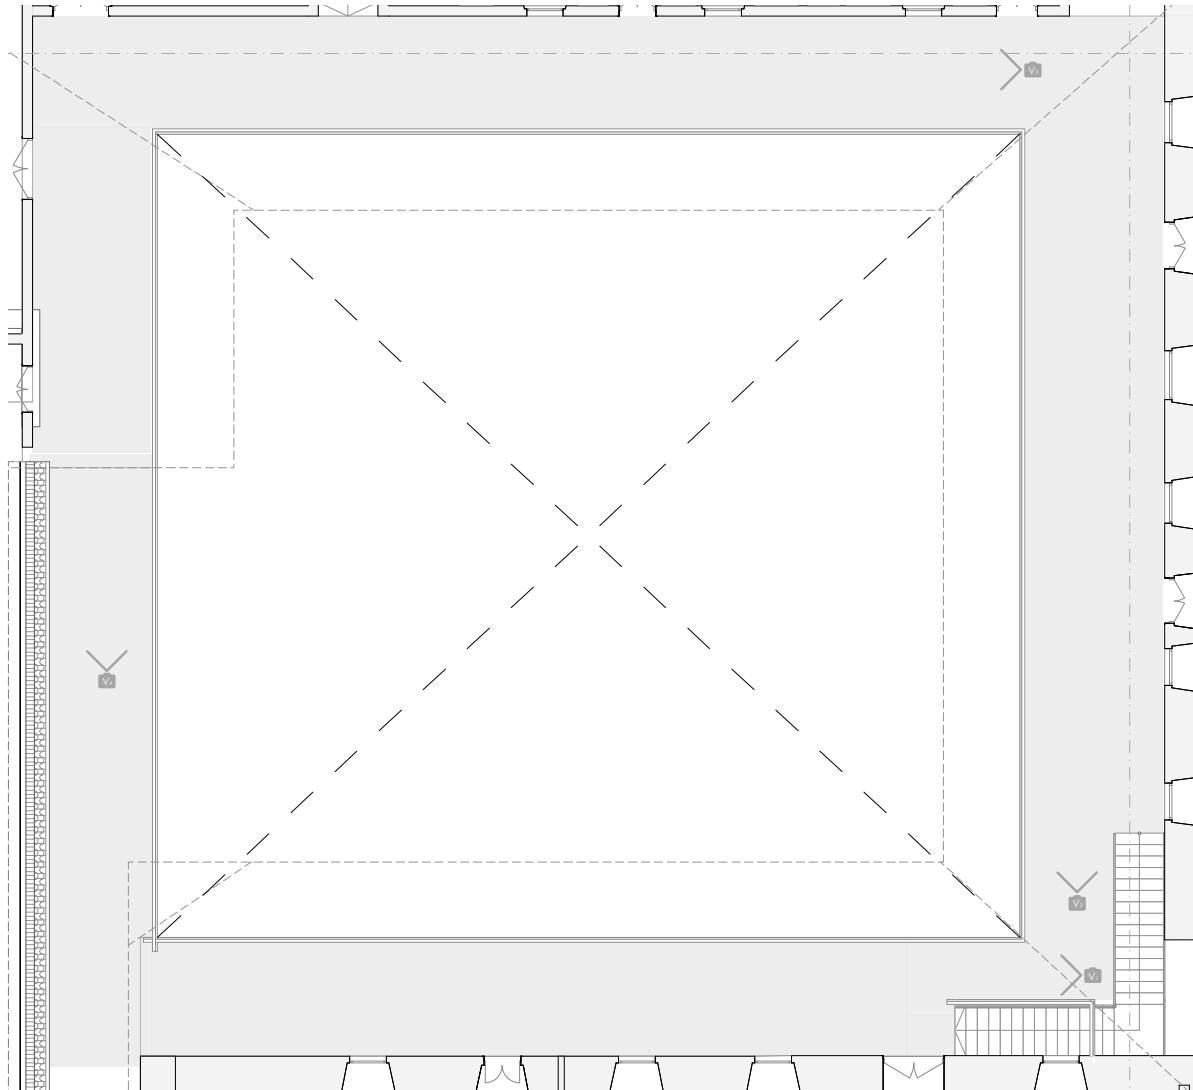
Vistas Pasillos Planta Alta. Elaboración Propia
